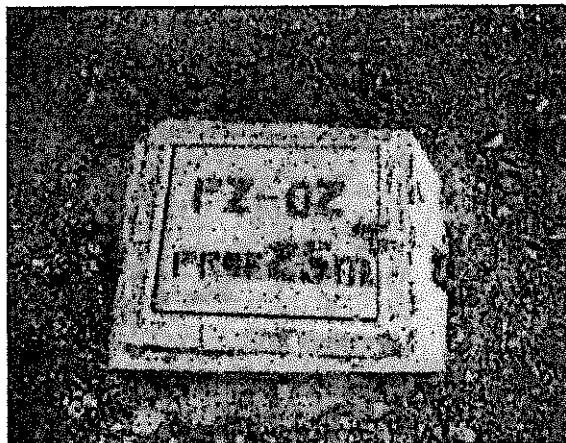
Instalación de Piezómetro PZ - 02, ubicado de la parte baja de los Pads de lixiviación.
